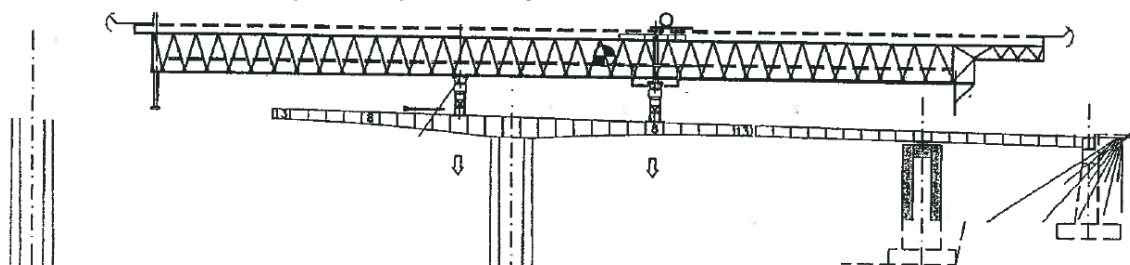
Fase de avanço, com a lançadeira em consola.
